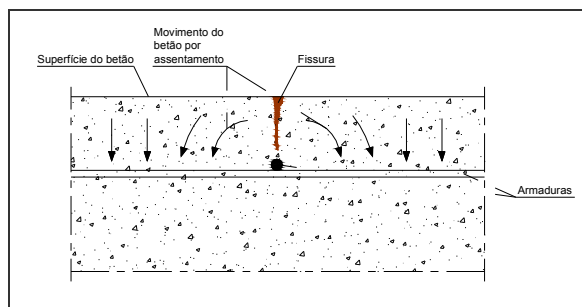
Fissura por assentamento plástico.
